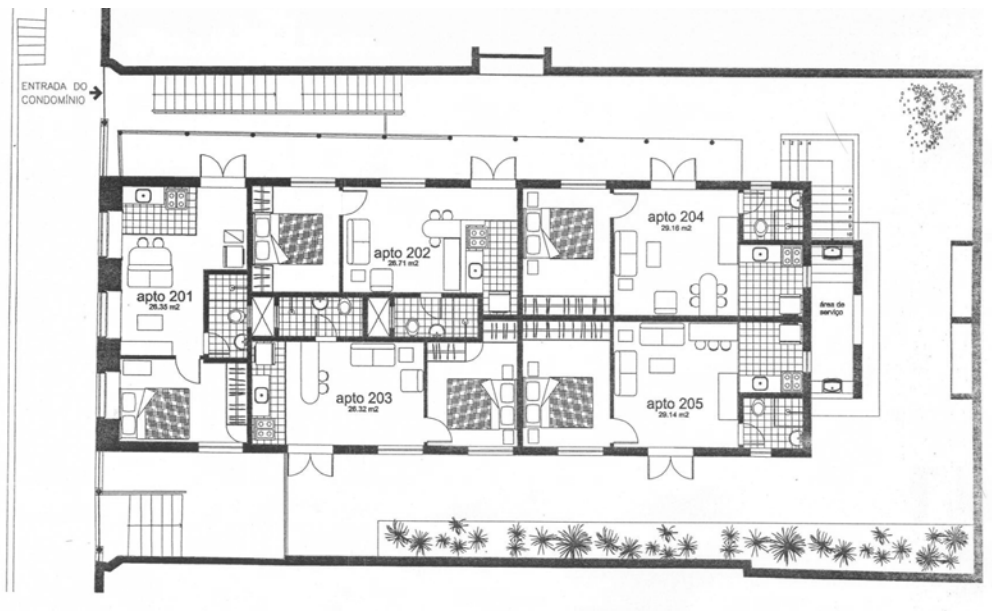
Rua Francisco Muratori, 38 – Planta baixa segundo pavimento (FREIRE, 1999, p. 4).
